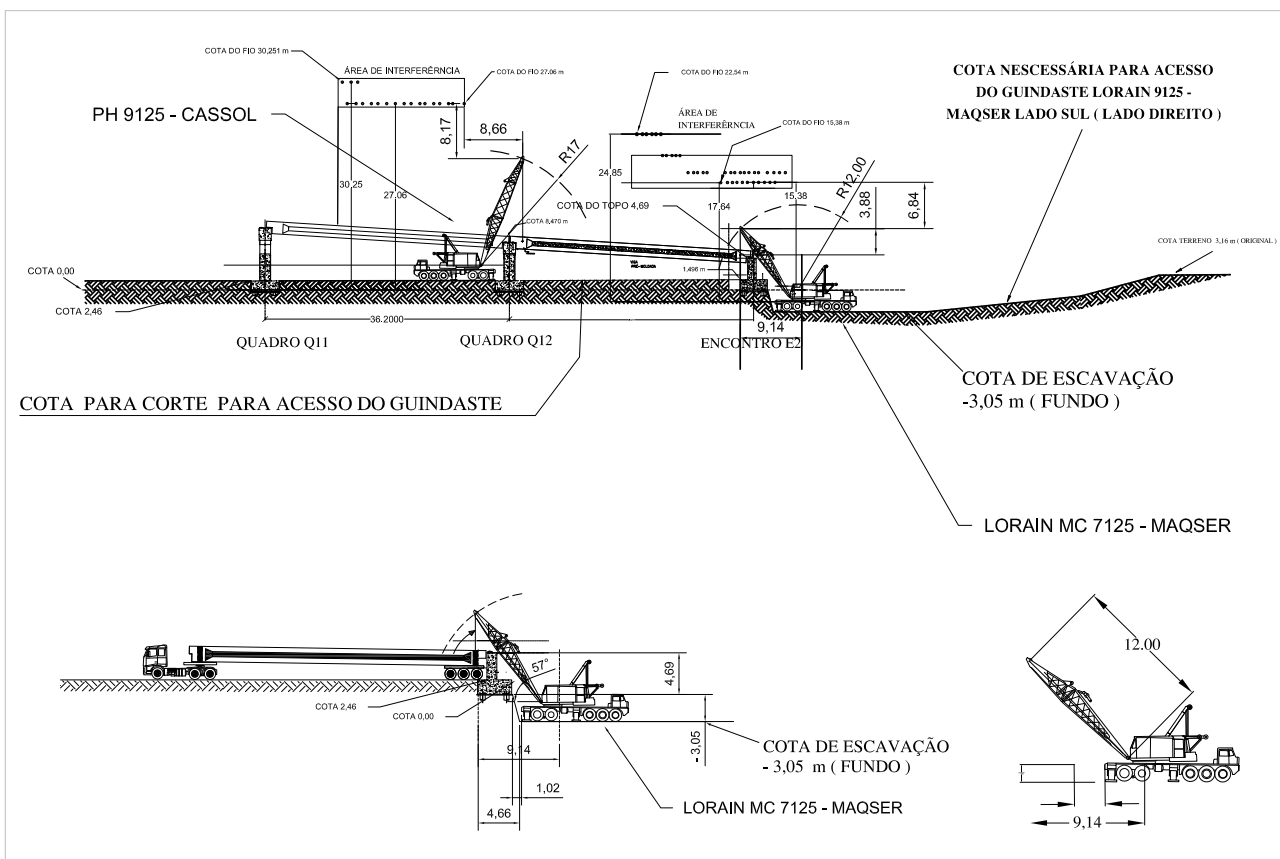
Plano de Rigging esquemático para montagem das megavigas (resp.: Eng. Wilton Ribeiro – gerente de produção da EBTE)
